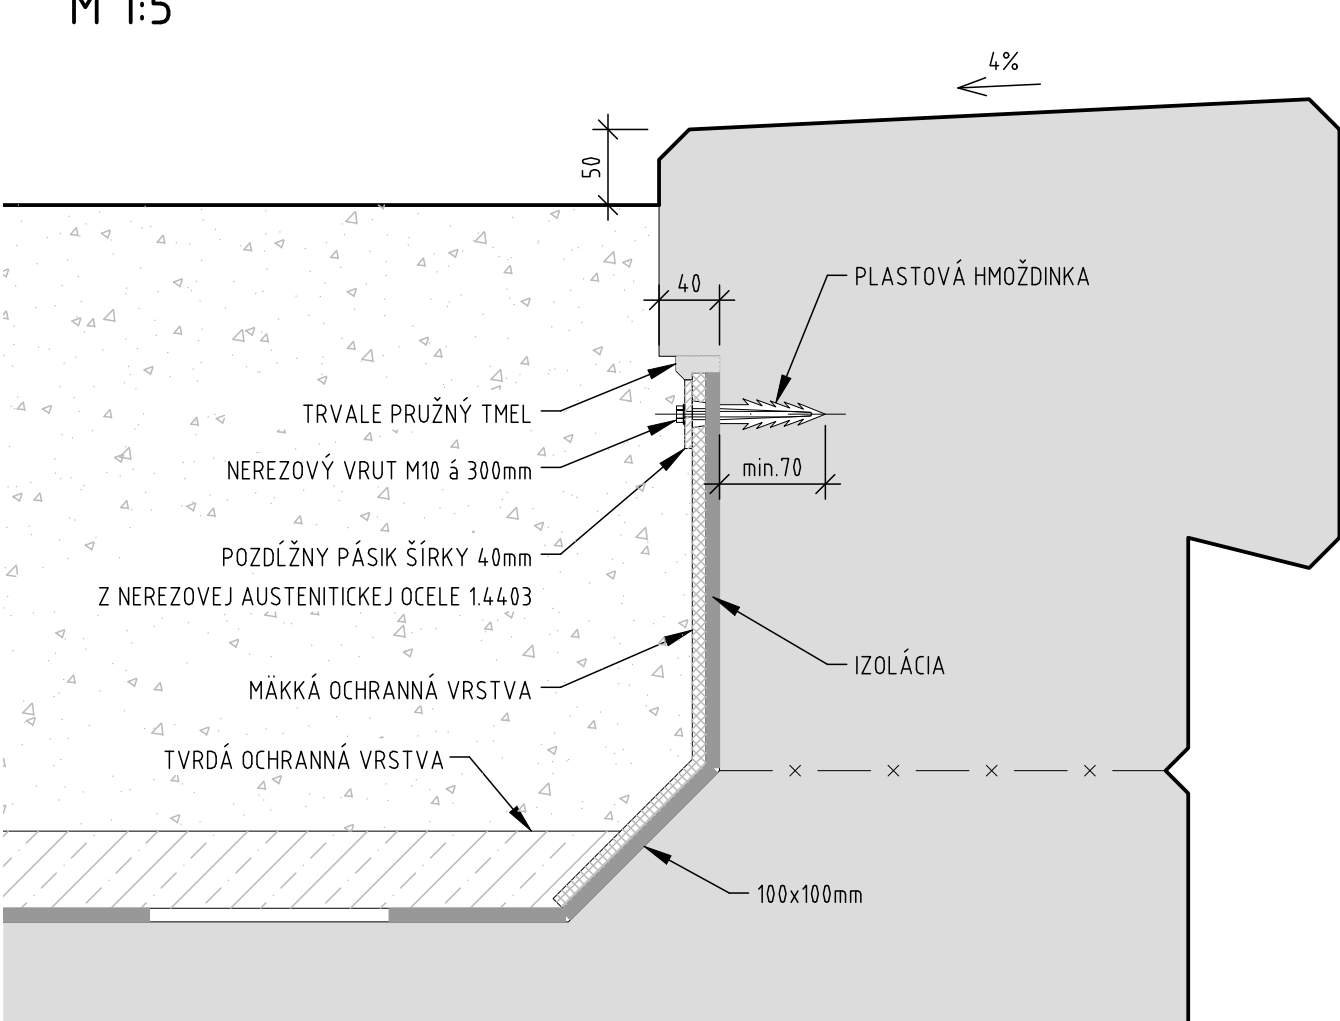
DETAIL UKONČENIA IZOLÁCIE POD DRENÁŽOU
